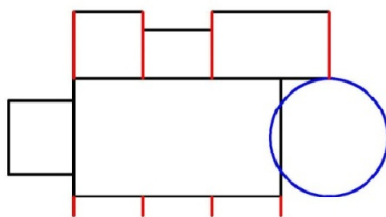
Esquema estrutural da Ermida São Domingos.
